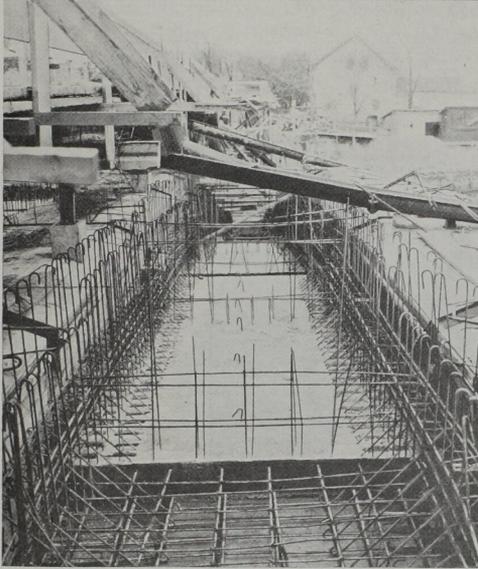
Wandarmierung einer Kastenrippe, Bodenplatte teilweise betoniert
